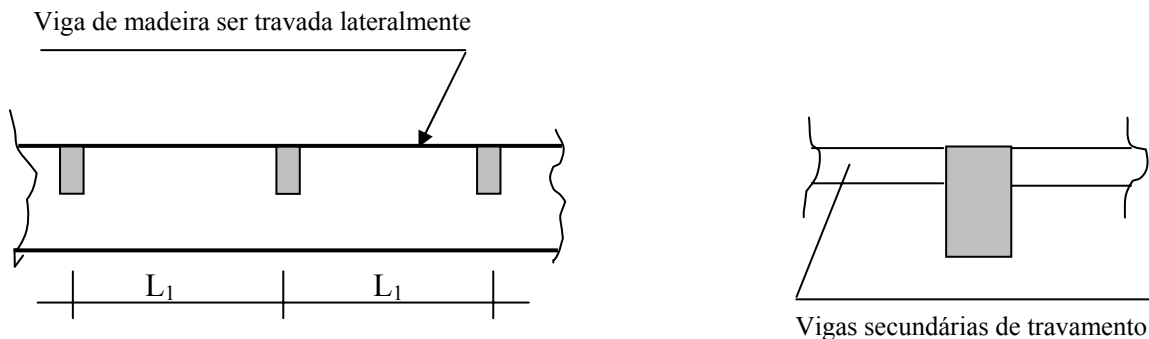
Travamento lateral isolado da mesa comprimida de uma viga de madeira, através de vigas de madeira secundárias pregadas ou parafusadas
